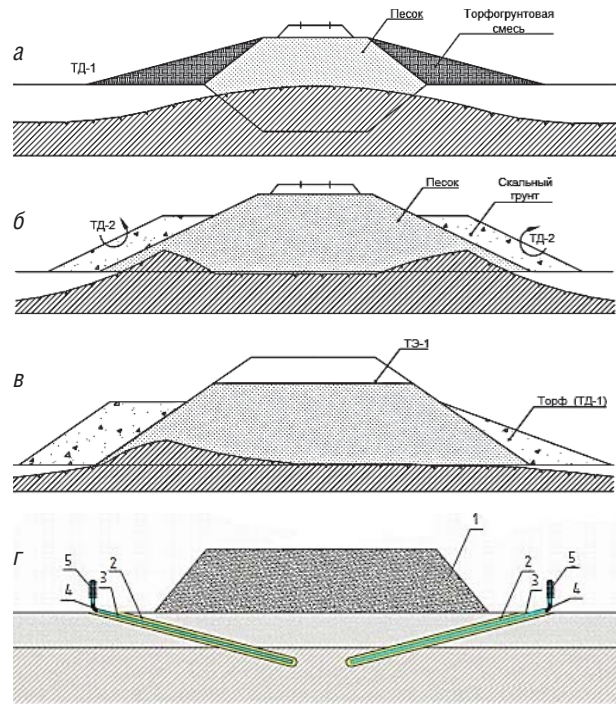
Некоторые конструкции земляного полотна в зоне вечномерзлых грунтов:
